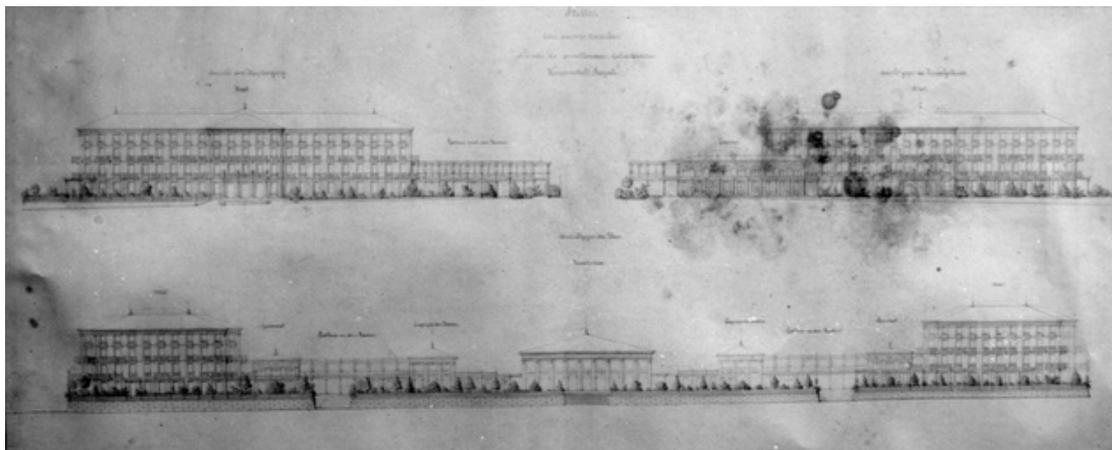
Bad Ragaz, Plan 6, Aufriss der Kuranlagen
